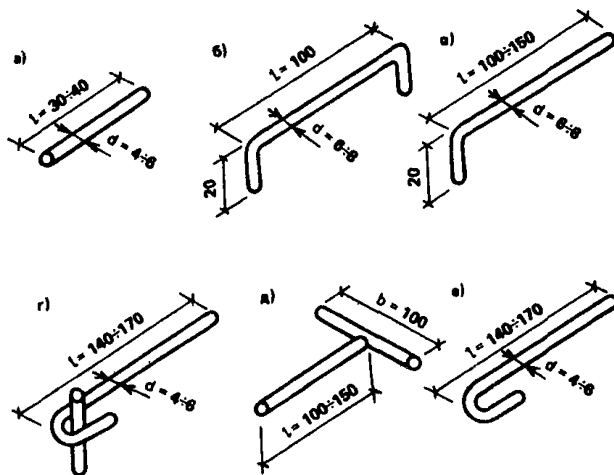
Металлические анкера для крепления плит из натурального камня к облицовываемой поверхности
